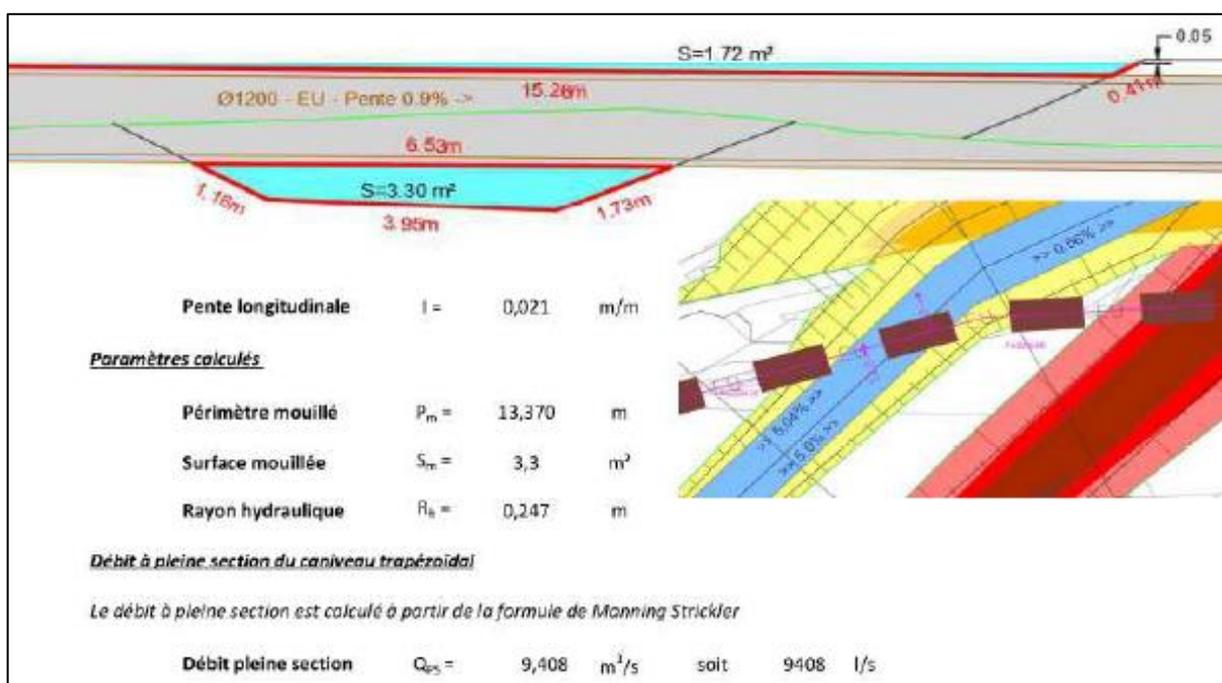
Vue en plan et extrait du profil en long de la dérivation au niveau du collecteur d'eau usée
